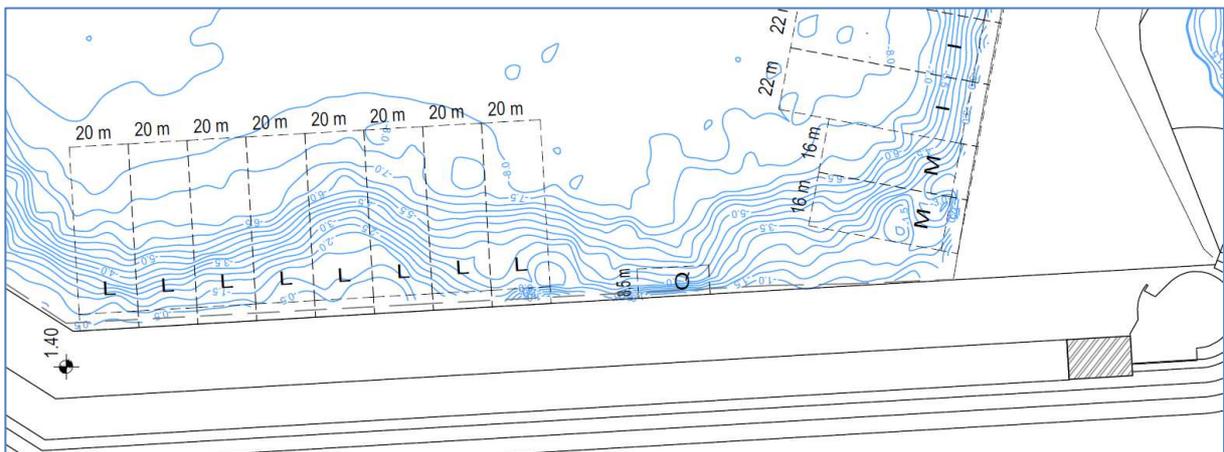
Stralcio disegno V3-D04-01: layout Molo Sud – dettaglio terzo braccio
